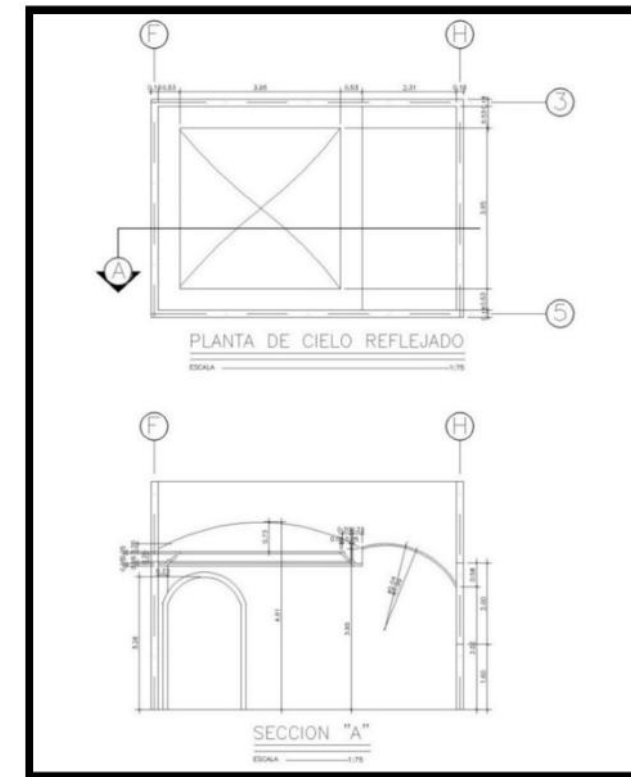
Planta arquitectónica dorm. pp. El Convento.
